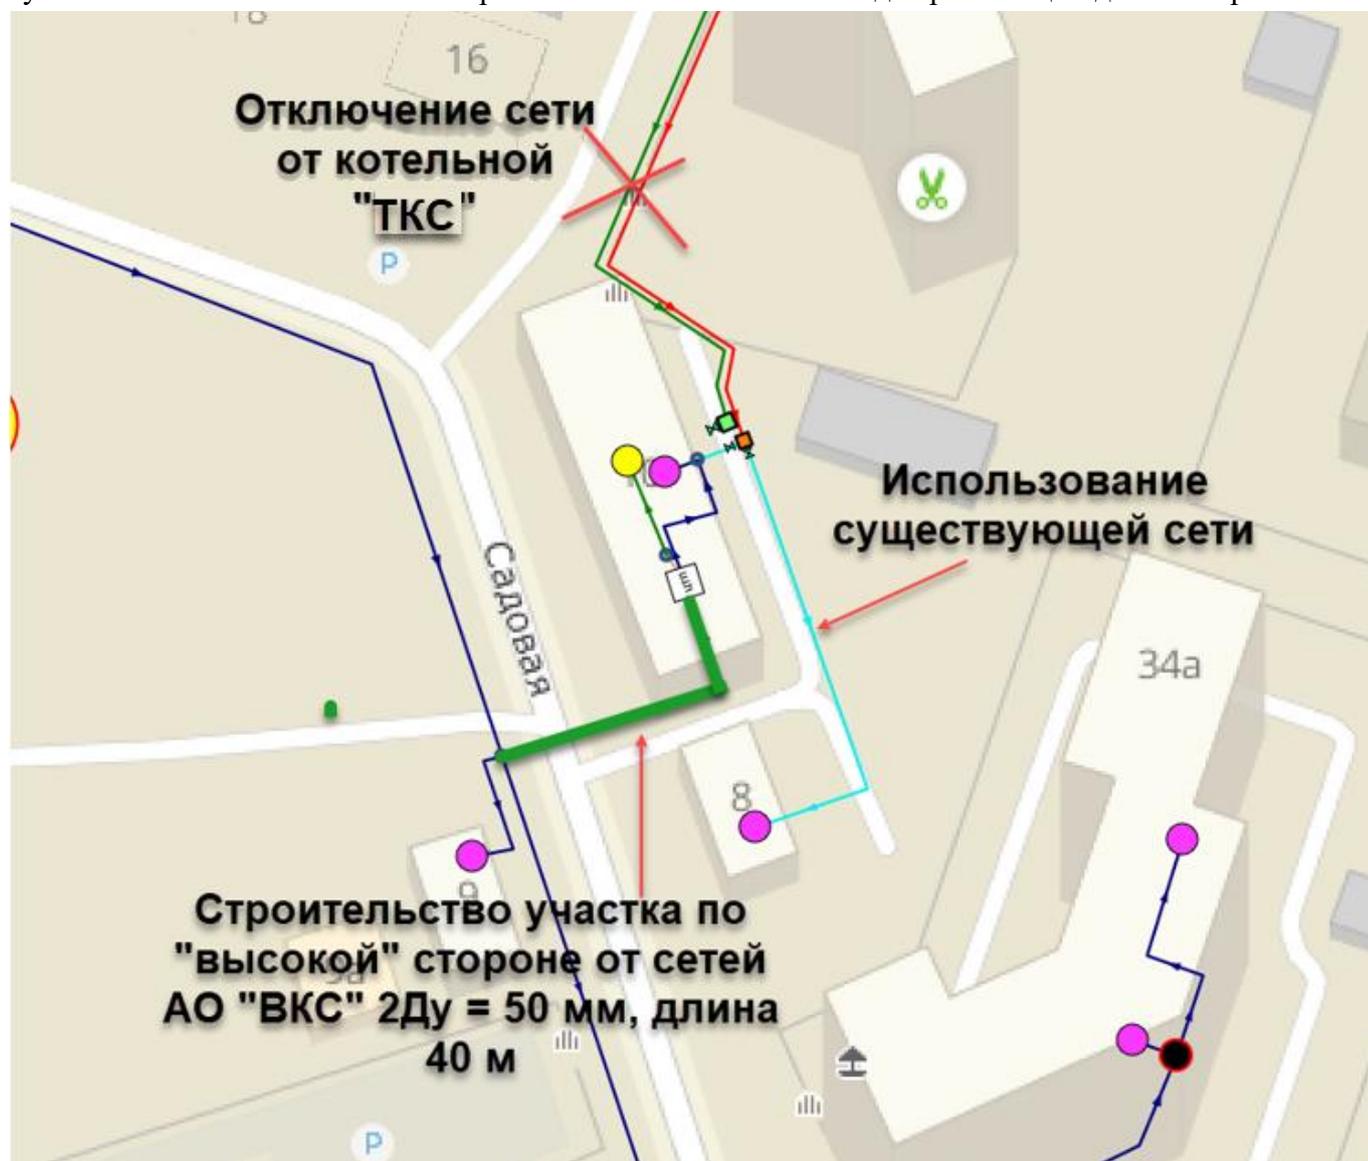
План по присоединению двух зданий ул. Садовая, д.10, ул. Садовая, д.8 от котельной «ТКС» к сетям Владимирской ТЭЦ-2
